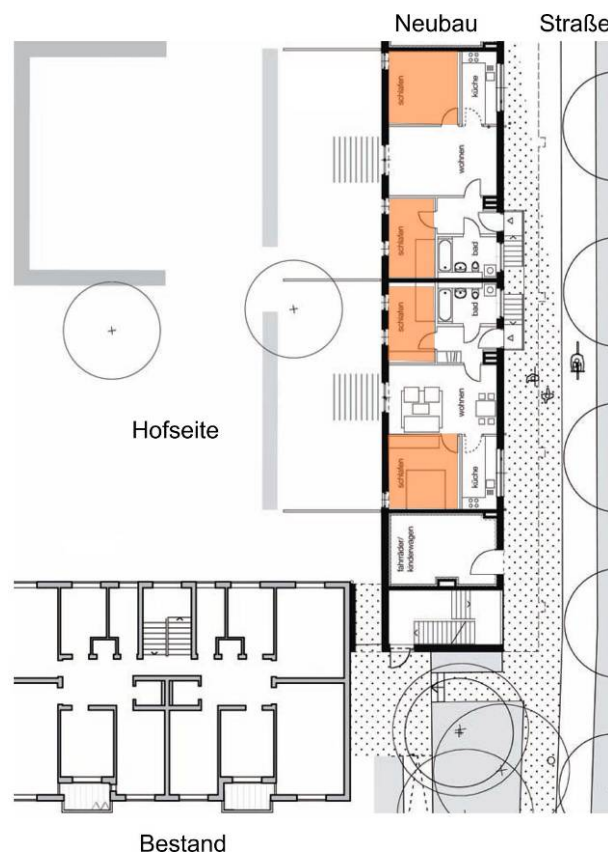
Grundriss Erdgeschoss (Schlafräume braun markiert), (Krieger Architekten)
